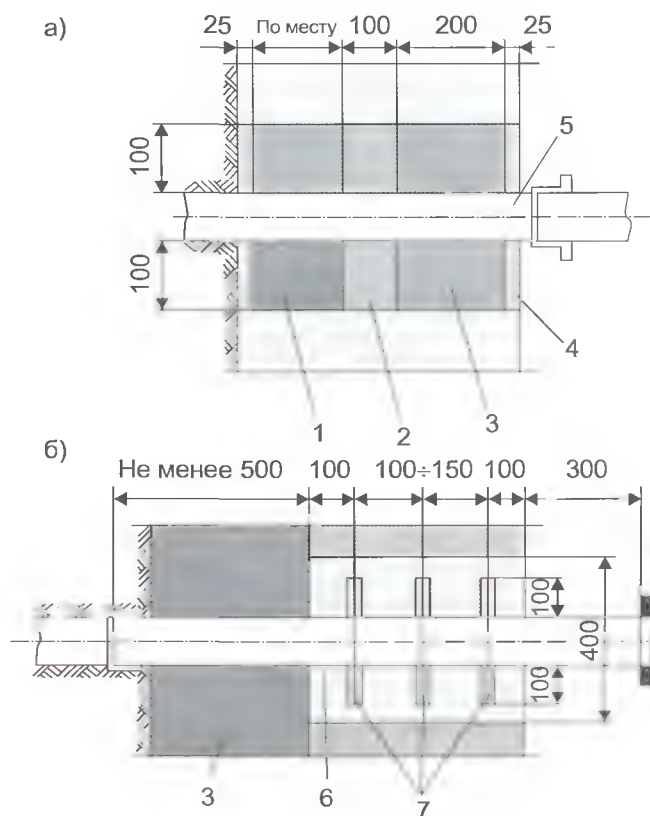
Прокладка водопроводного ввода через стену подвала:
